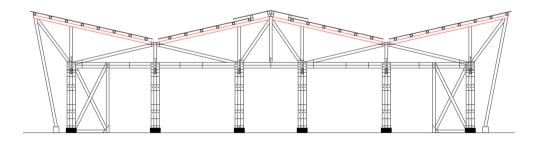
Secciones de Pares de Sobrecubierta en Vista Transversal. Fuente: [Propia]
